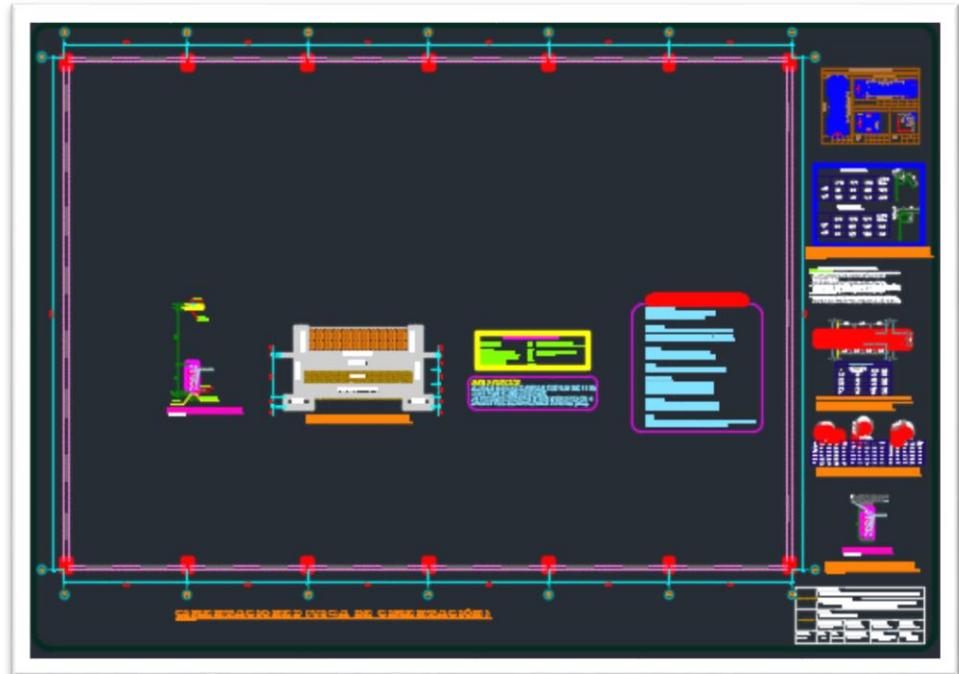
E-05-CIMENTACIONES Y DETALLES.
